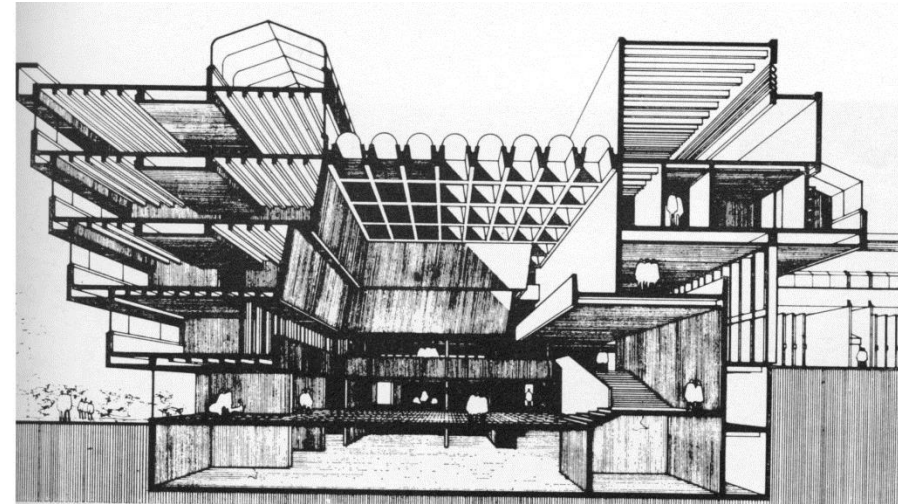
Corte transversal do Scarborough College mostrando o escalonamento dos pavimentos.
